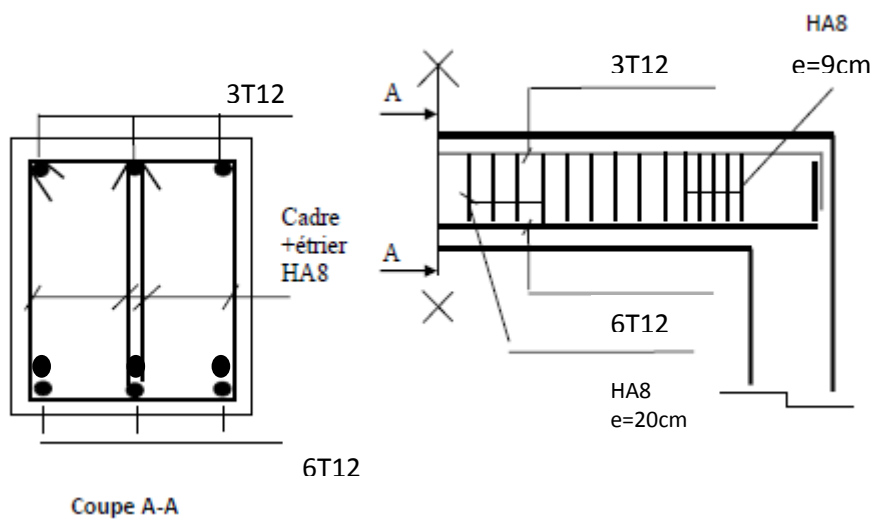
Schéma de ferrailage de la poutre palière.
